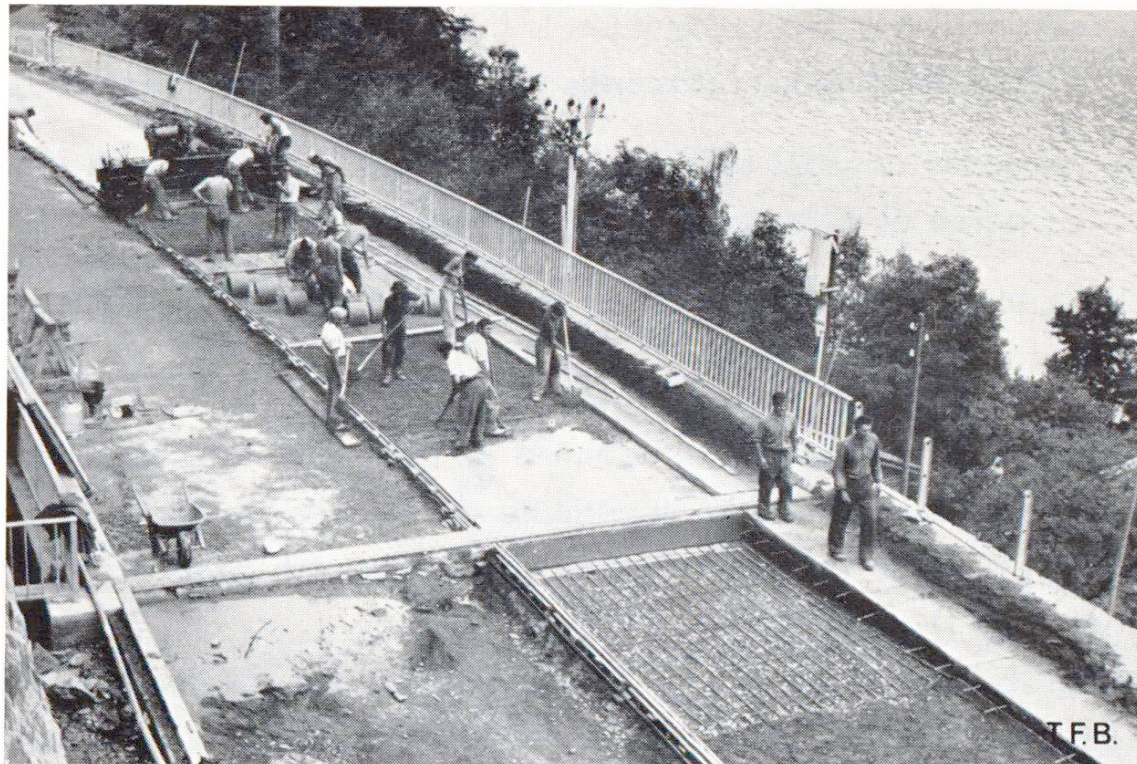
Construction du revêtement en béton d'un pont. On voit, au premier plan, l'armature d'une dalle de transition, puis le joint entre route et pont, la mise en place d'une couche de béton du revêtement, les treillis chauffants et enfin, le revêtement terminé
